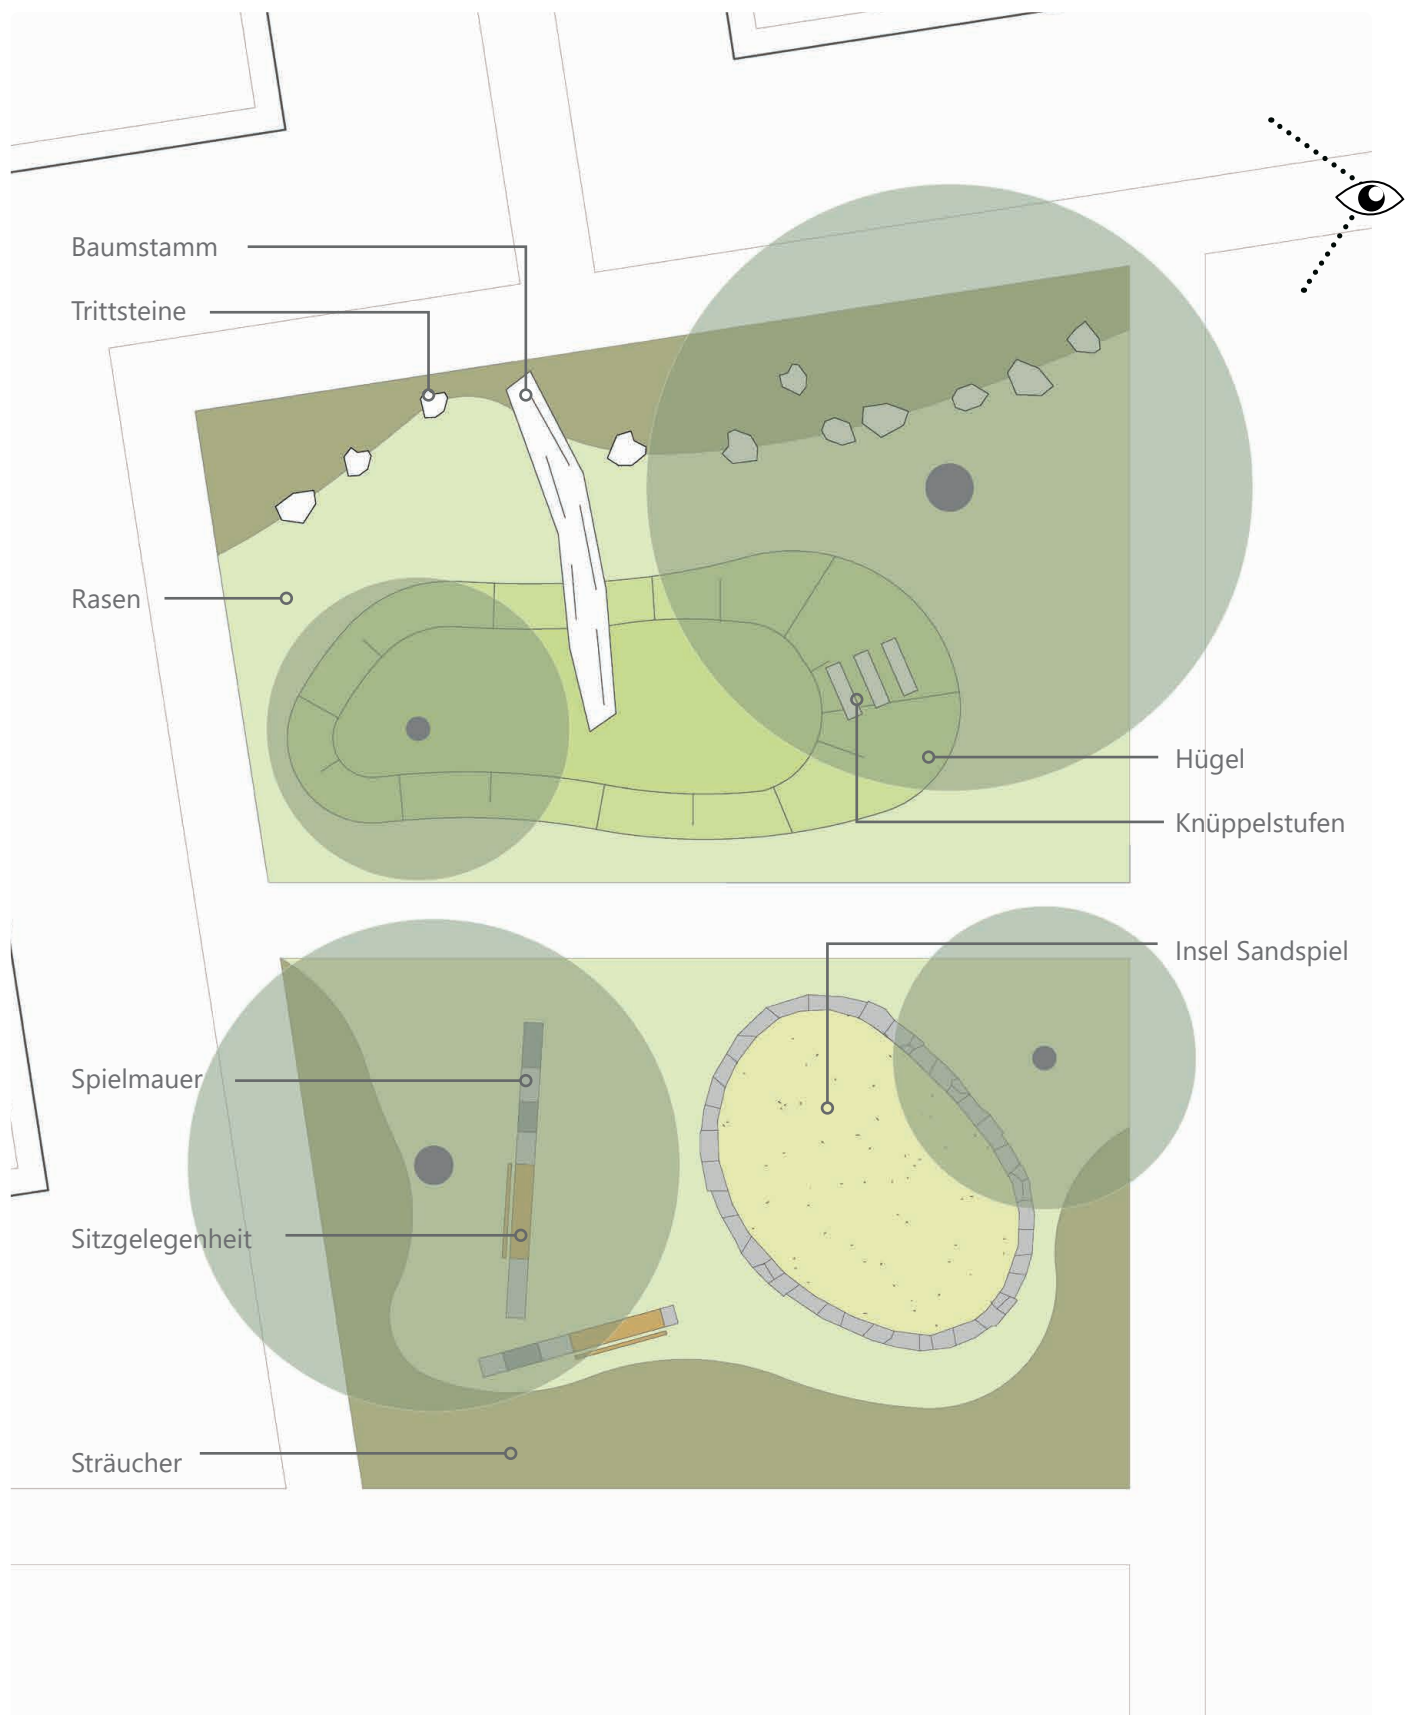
Lageplanausschnitt der Innenhof-Spielfläche (M 1:200)
